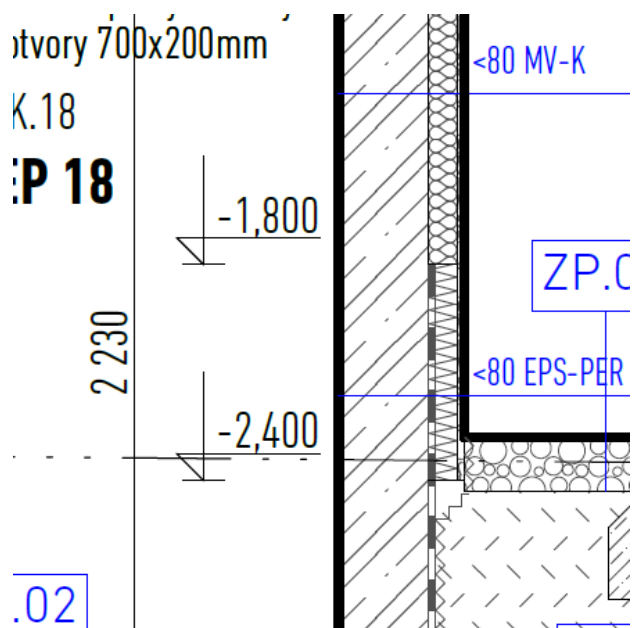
a 10 – Doplnění skladby SO.04 do skladeb obvodových konstrukcí a doplnění označení skladby do Půdorysu 1.PP
